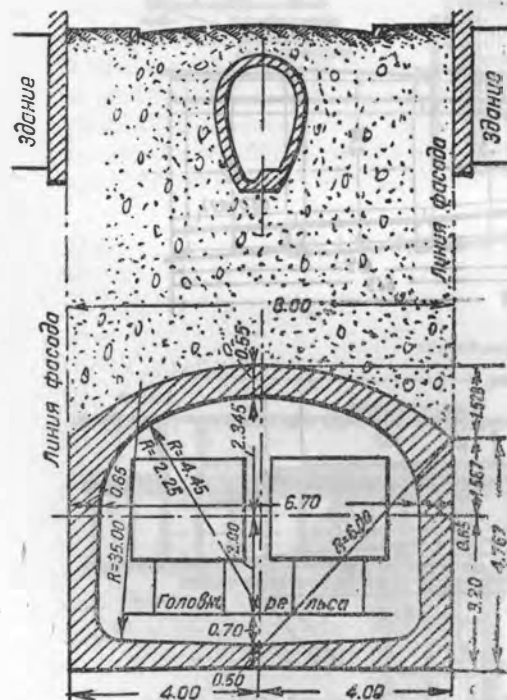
Проходка двухпутным тоннелем под ул. „Оле“. Внешние грани стен тоннеля срезаются по плоскостям фасадов домов.
